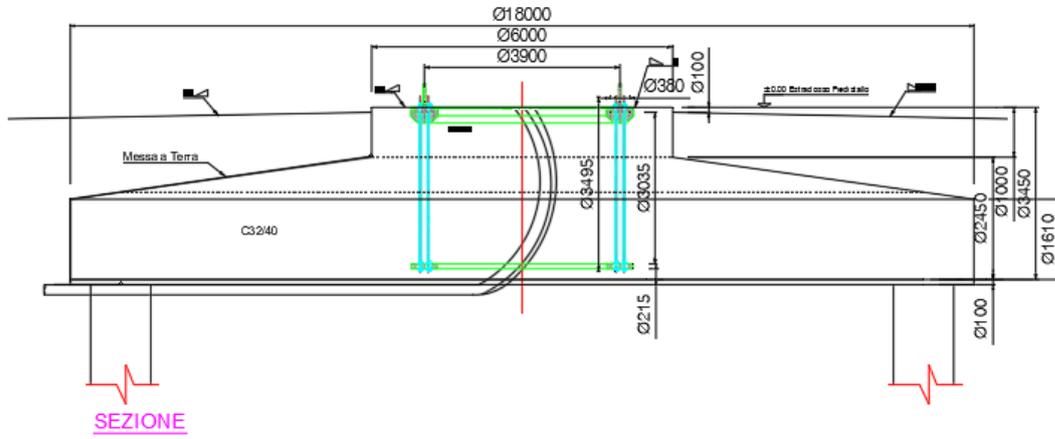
Sezione tipo dell'opera di fondazione in conglomerato cementizio armato
